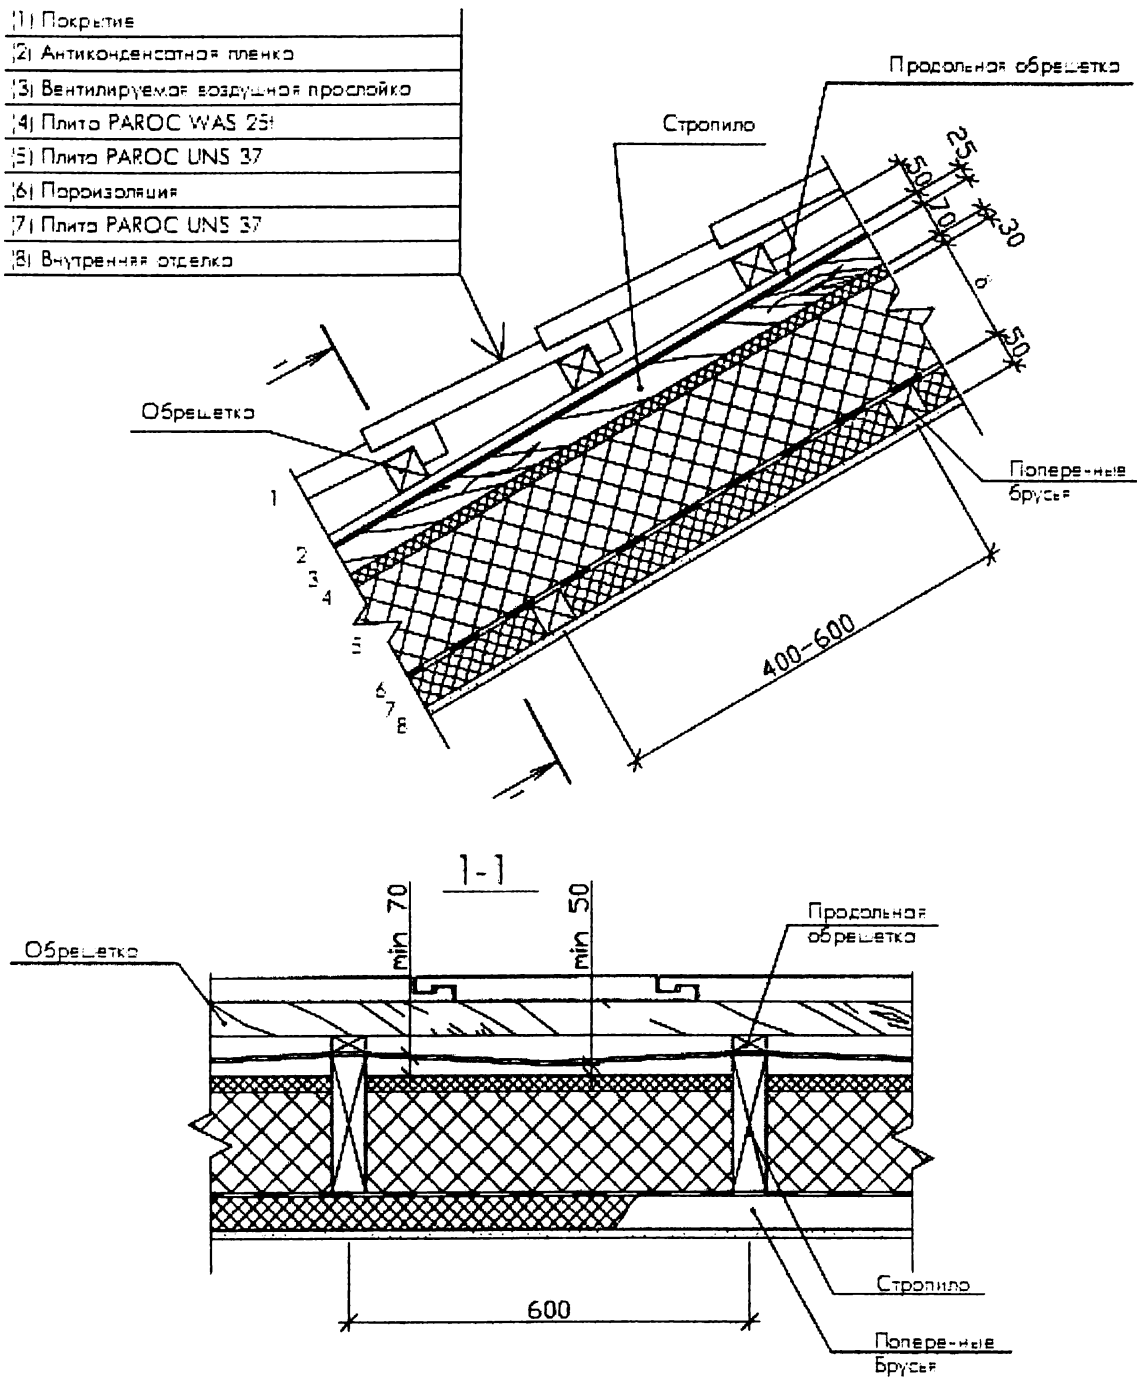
Скатная кровля с черепичным покрытием и паропроницаемой гидроизоляционной пленкой
